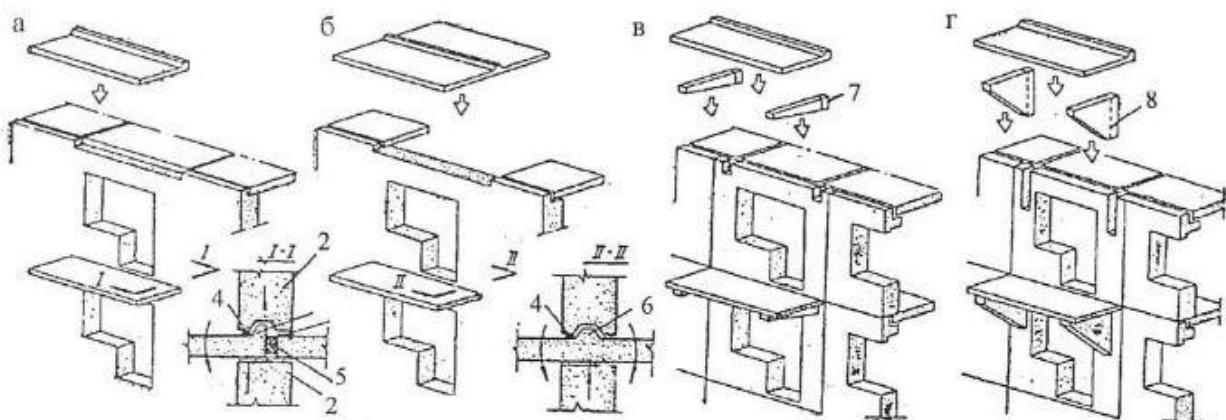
Схема передачи изгибающего момента и вертикальных усилий от балконной плиты на конструкцию: а – наружной несущей стены; б – легкобетонной панели перекрытия (и наружной
